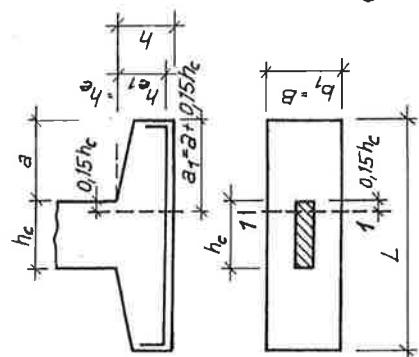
Porovnání patky z prostého betonu a ze železobetonu.
